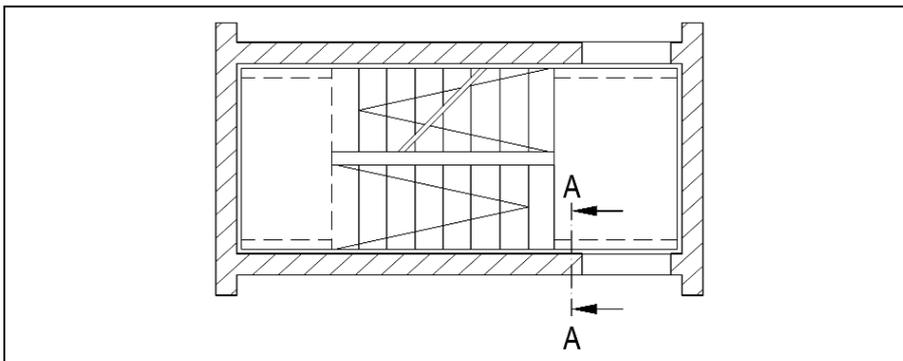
Schwimmender Estrich auf den Podesten bei elastischer Auflagerung der Treppenläufe (Grundriss).
